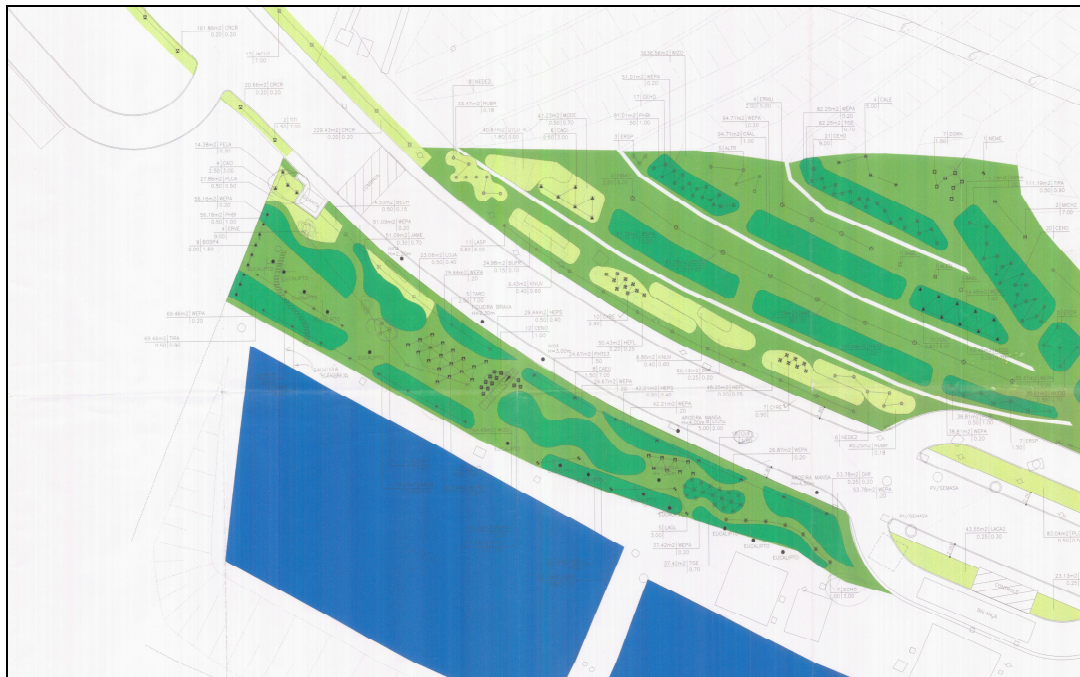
Planta do Projeto Paisagístico Piloto para o Aterro Sanitário de Santo André
